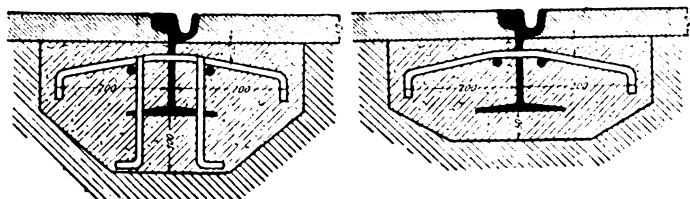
Sistema Elsig di posa delle rotaie tramviarie con pavimentazione in asfalto.
